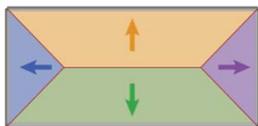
Losa perimetralmente apoyada, se indica la distribución de cargas a vigas exteriores usando trapecios y triángulos.
